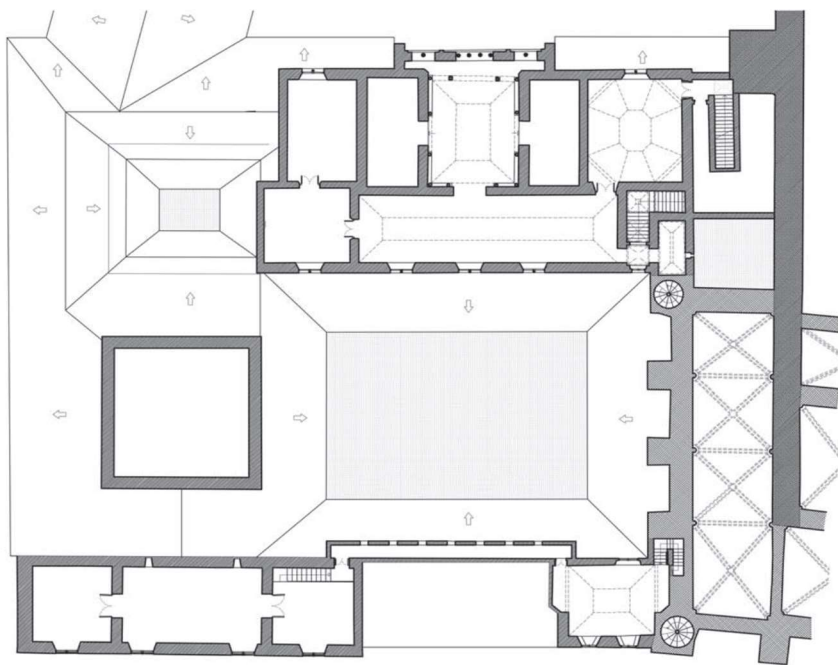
Hipótesis de la planta alta del palacio mudéjar tras el reinado de Pedro I. Ésta sería la planta que más modificaciones sufriría durante el reinado de los Reyes Católicos. Tomado de Antonio Almagro Gorbea, “la planta alta del palacio...”, p.83
